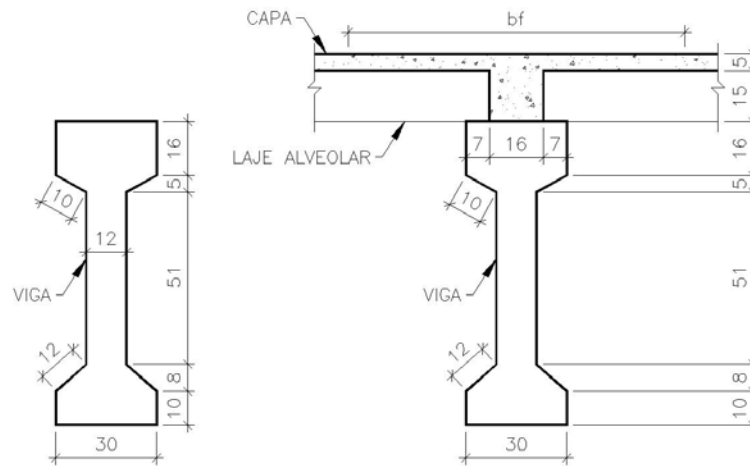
Seções transversais da viga VR01 (unidades em cm).
